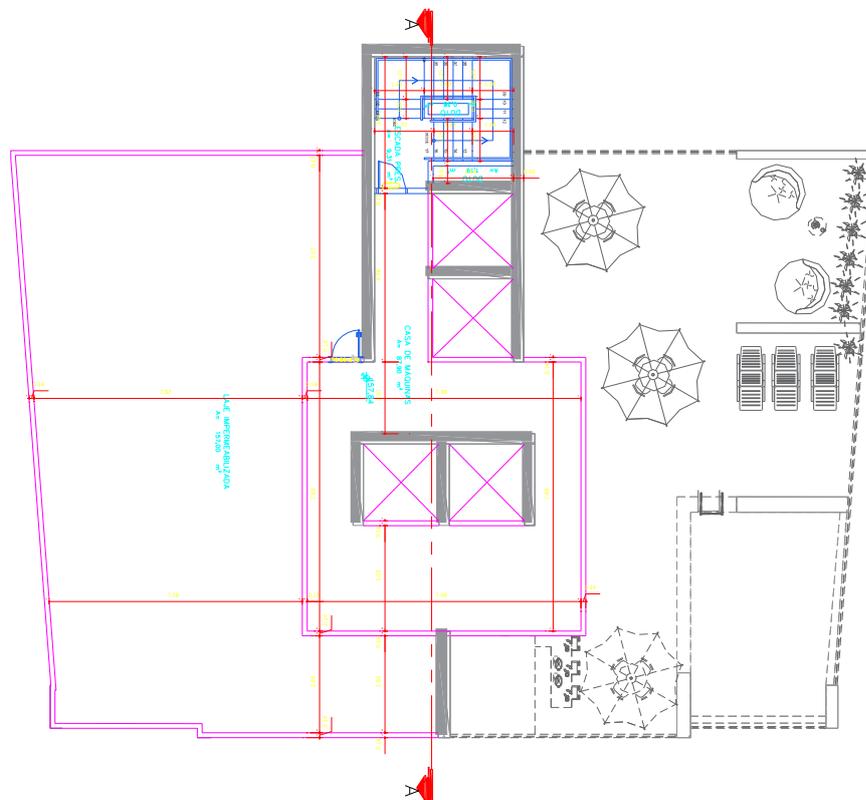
Planta Baixa pavimento c.maq., barrilete, reservatório.
